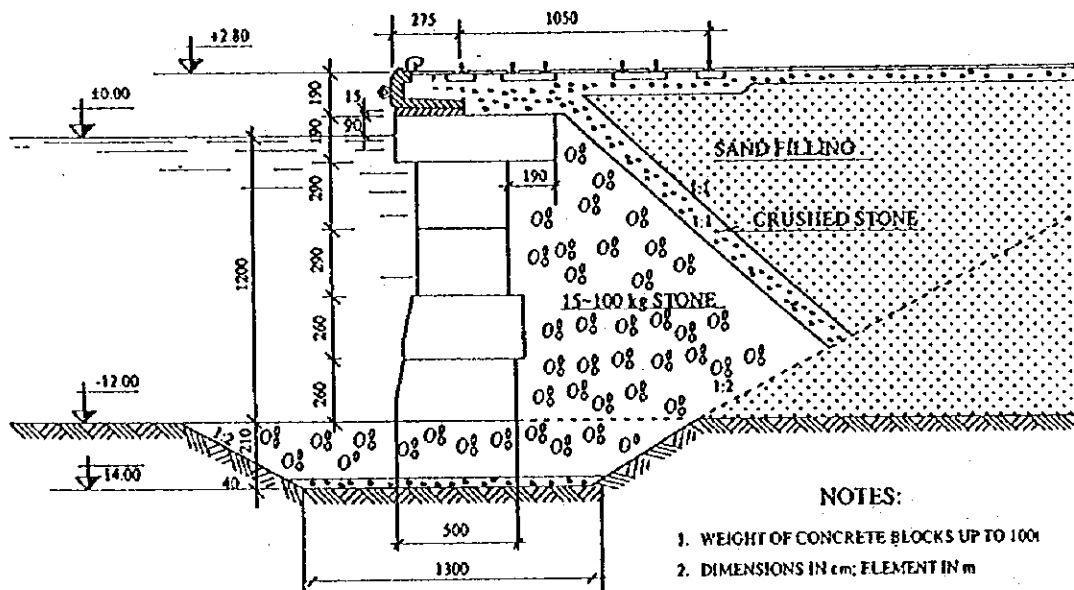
岸壁标准断面图—重力式 (-12.0m)
